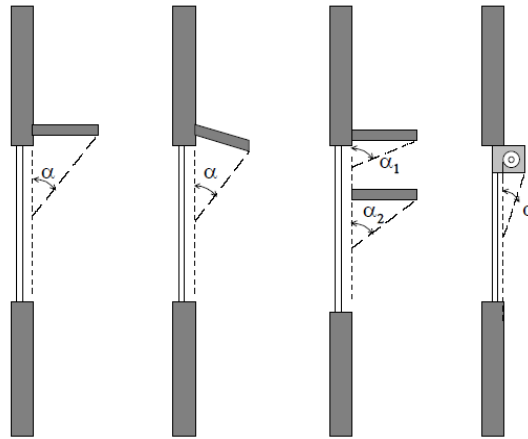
Exemplos de medição do ângulo α de palas e de outros elementos "horizontais" (secção vertical) sobrepostos ao vão envidraçado [7]
